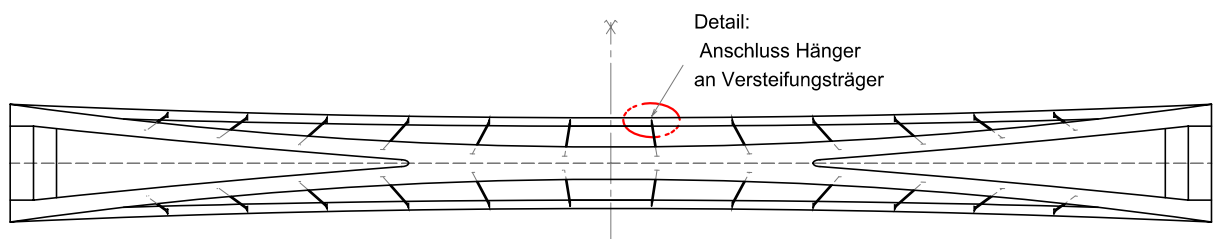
Grundriss der Stabbogenbrücke
